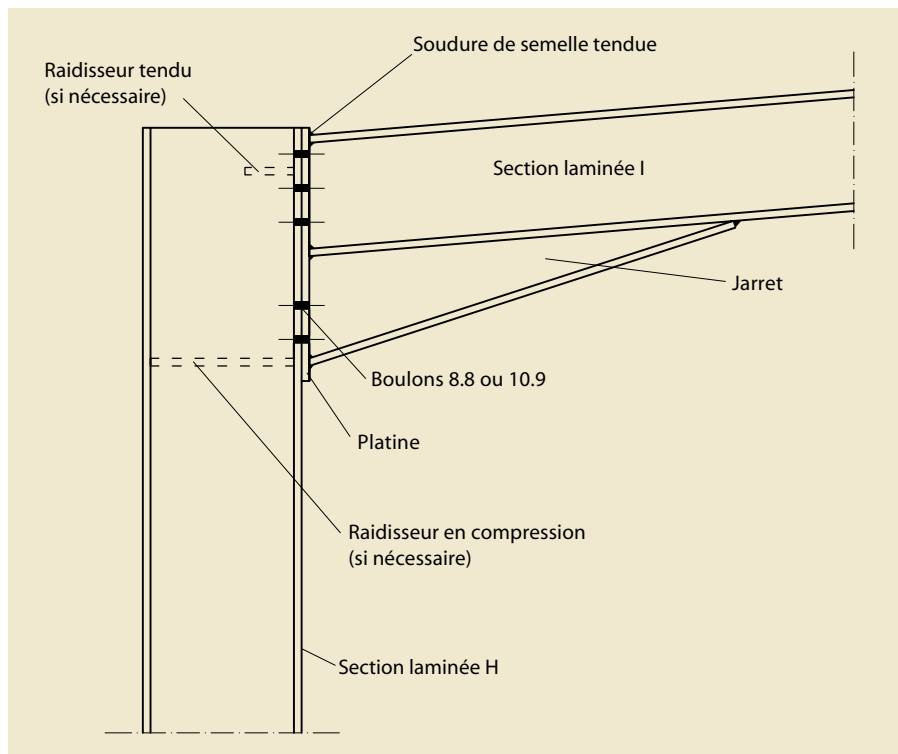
Assemblages poteaux-poutres typiques dans un portique
